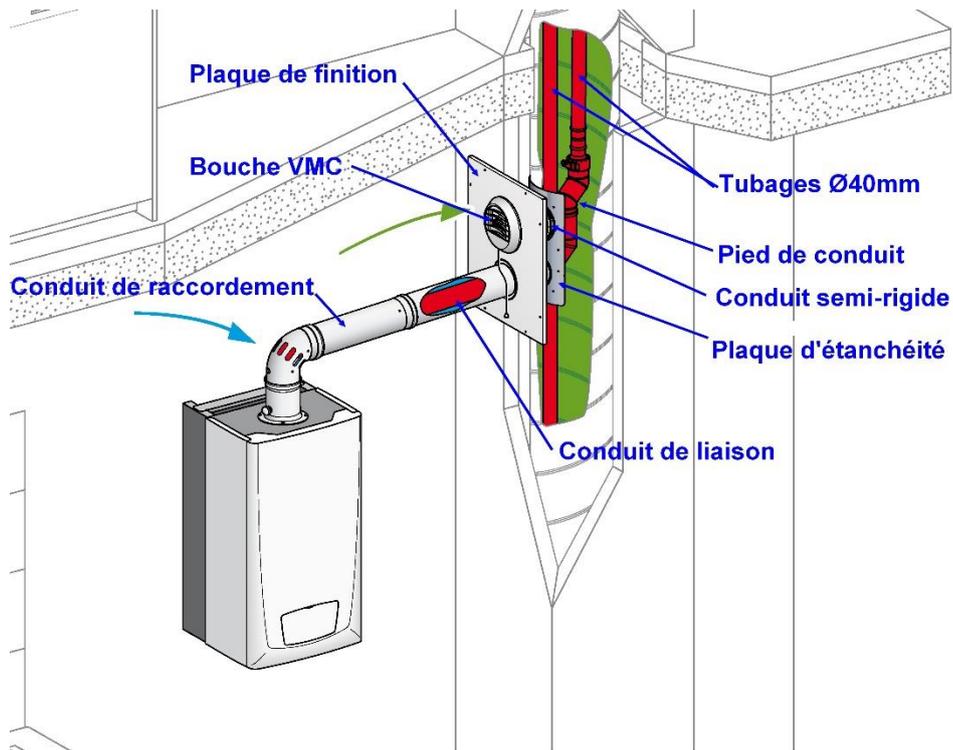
Représentations du Pied de conduit, Raccordement chaudière, Bouche VMC, plaque d'étanchéité et plaque de finition
